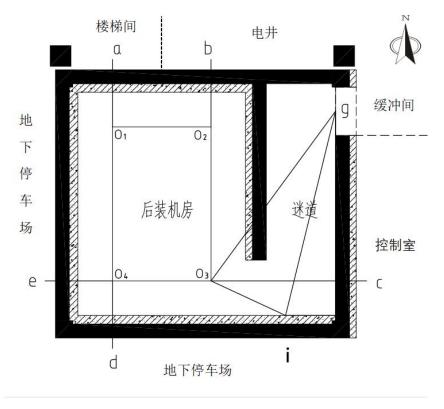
后装机机房外关注点位示意图 (平面图)
